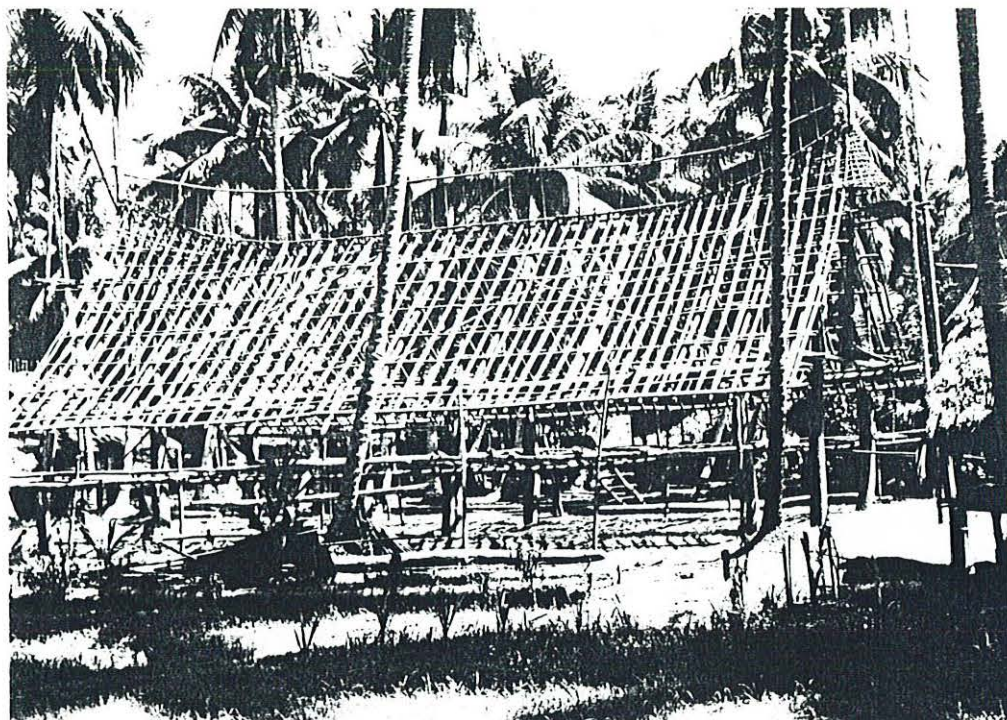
Nouvelle maison cérémonielle en construction à Marap. La structure de charpente de toiture est bien visible (1988).
